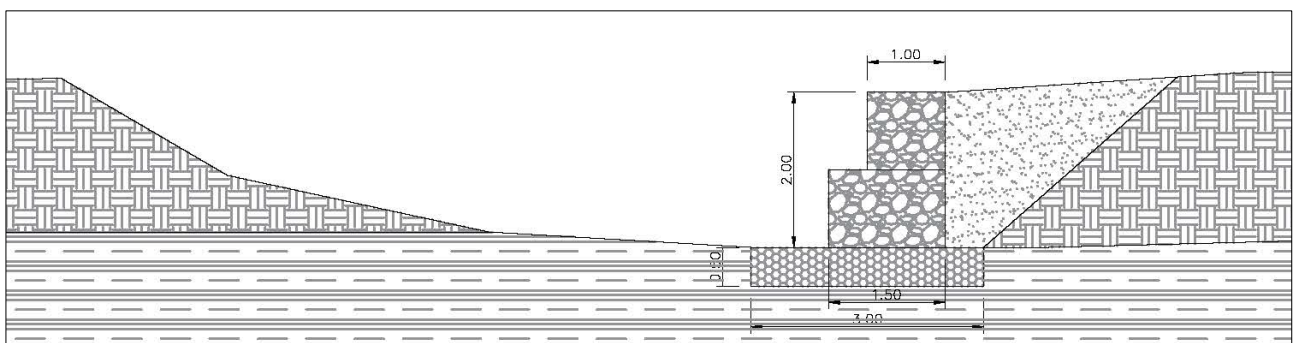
Particolare sezione tipo delle opere di difesa spondale oggetto di dimensionamento
